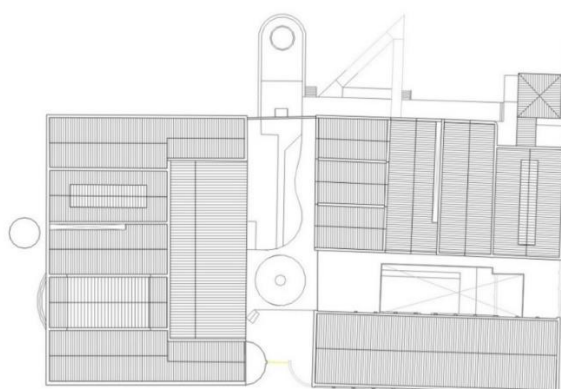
Planta de Coberta do ECOA. Sobral/Ce.
